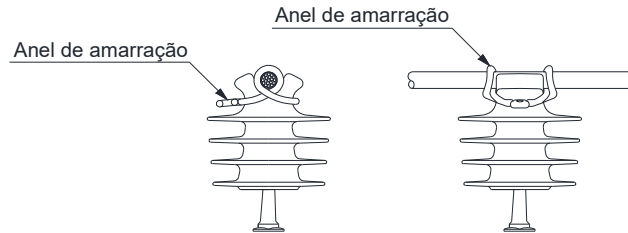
Amarrações e ligações – Amarração de topo do cabo protegido – Anel de amarração
